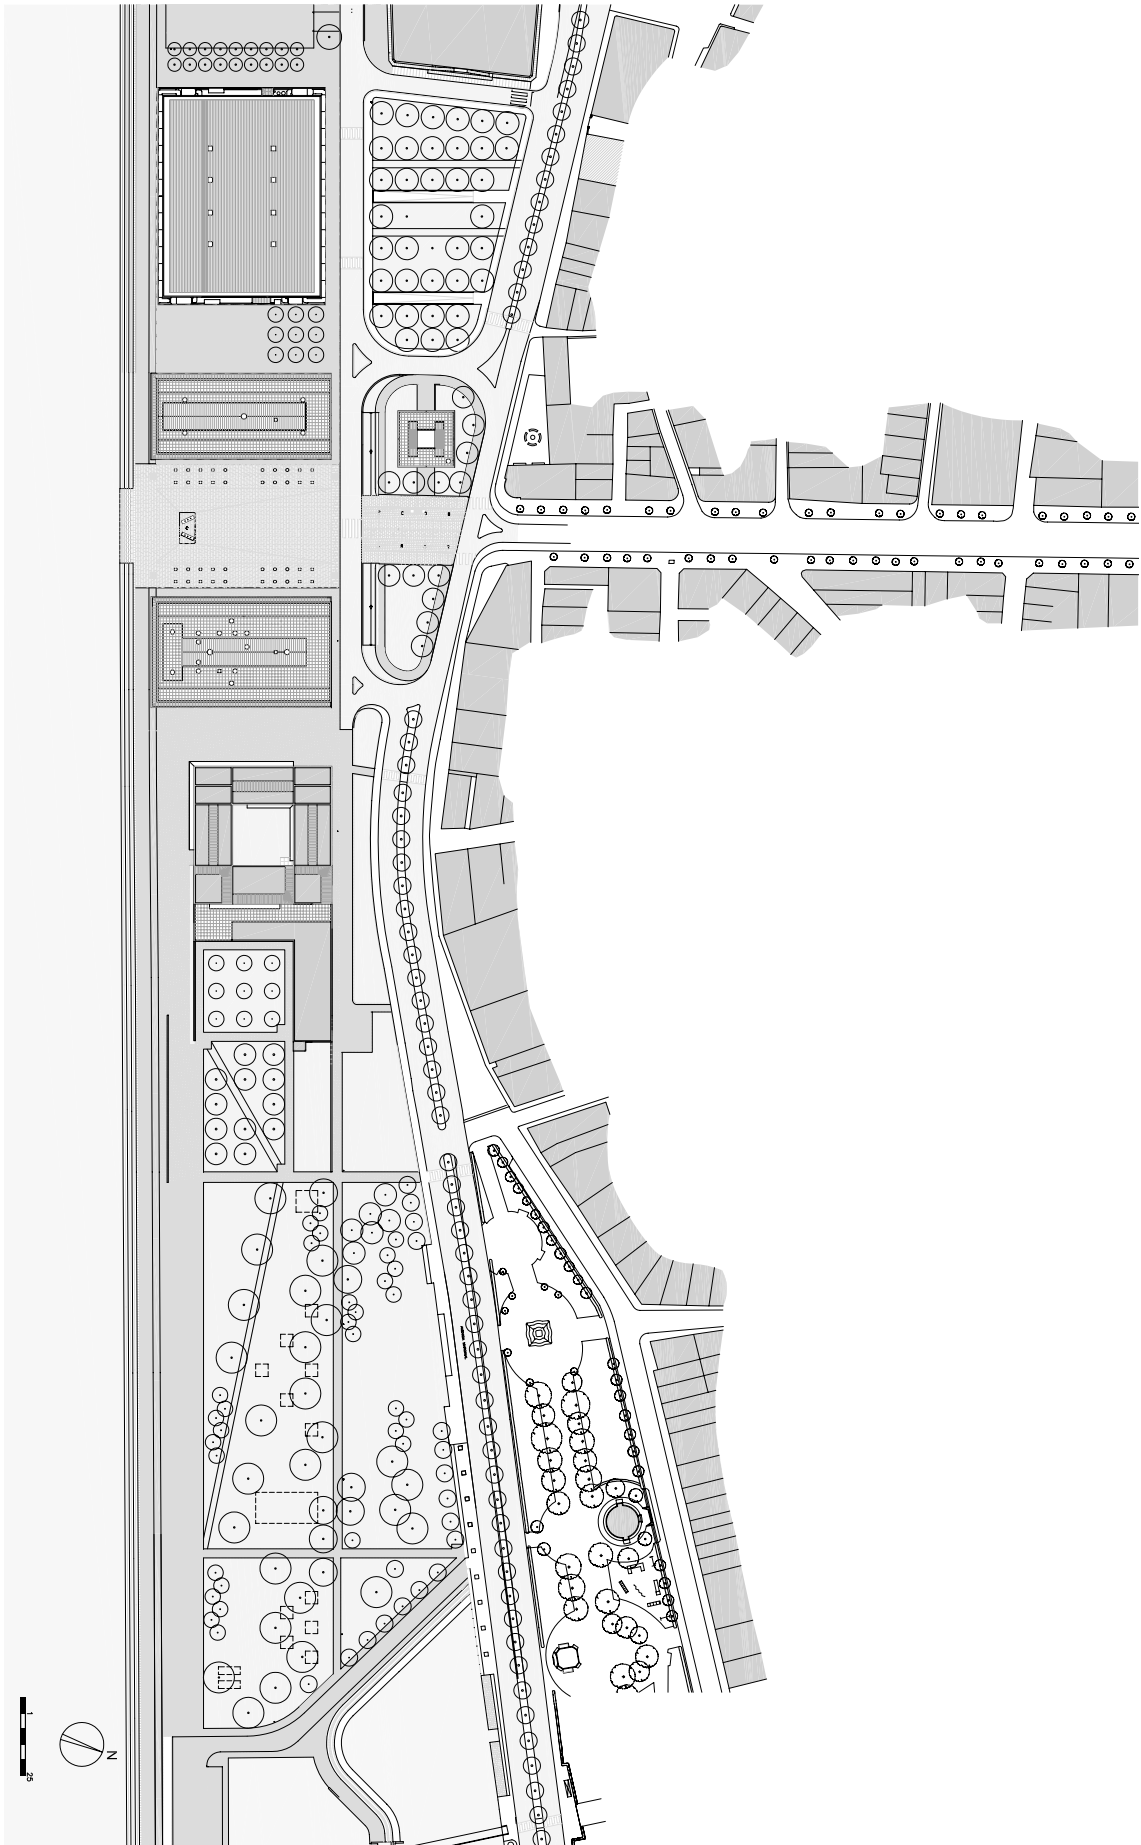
Planta de implantação da biblioteca e restante marginal
